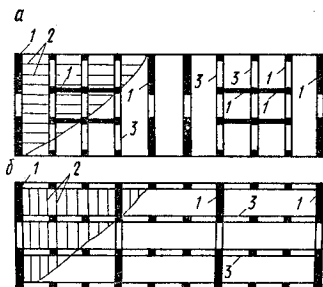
Конструктивные планы каркасных многоэтажных гражданских зданий
